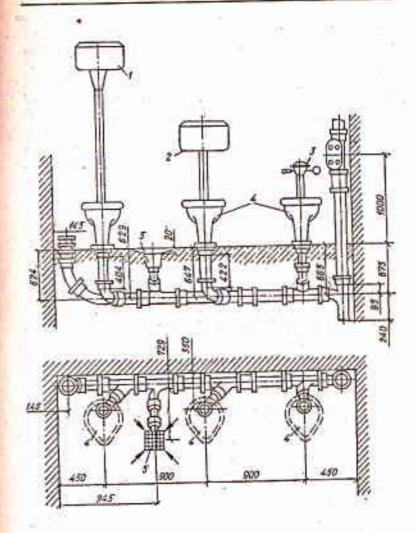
Установка унитаза с прямым выпуском: 1 — высокорасполагаемый бачок; 2 — среднерасполагаемый бачок; 3 — смывной кран; 4 — унитаз; 5 — трап
